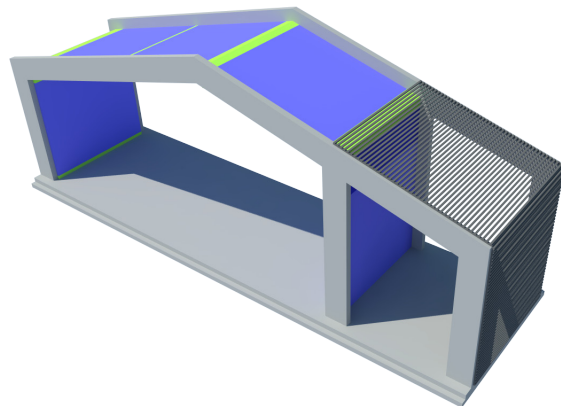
| Wandversatz mit stabilisierenden Fassadenelement
